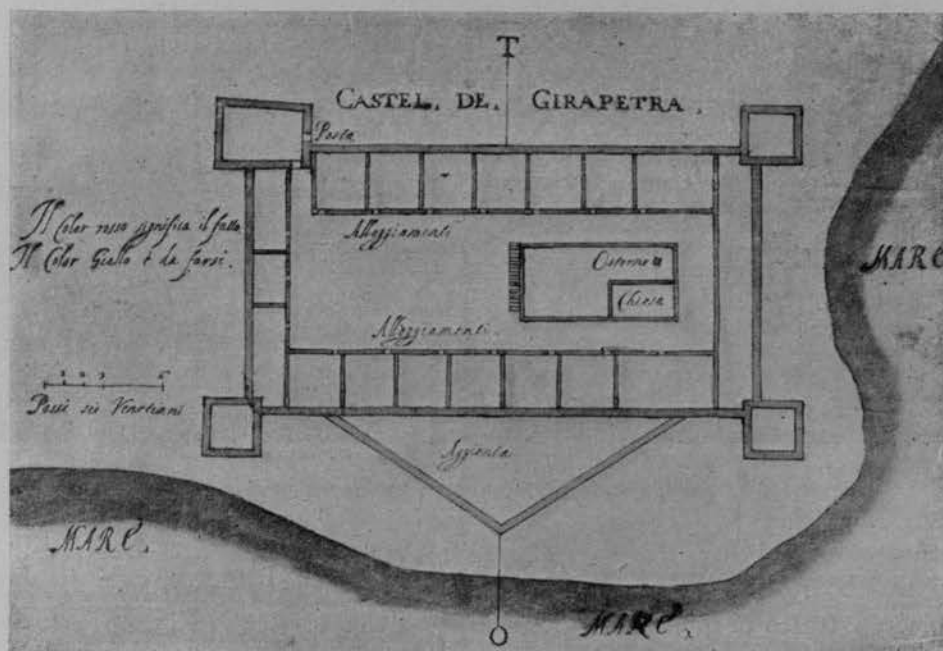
PIANTA DELLA ROCCA DI GERÀPETRA — 1627. (XXIX. b.).
